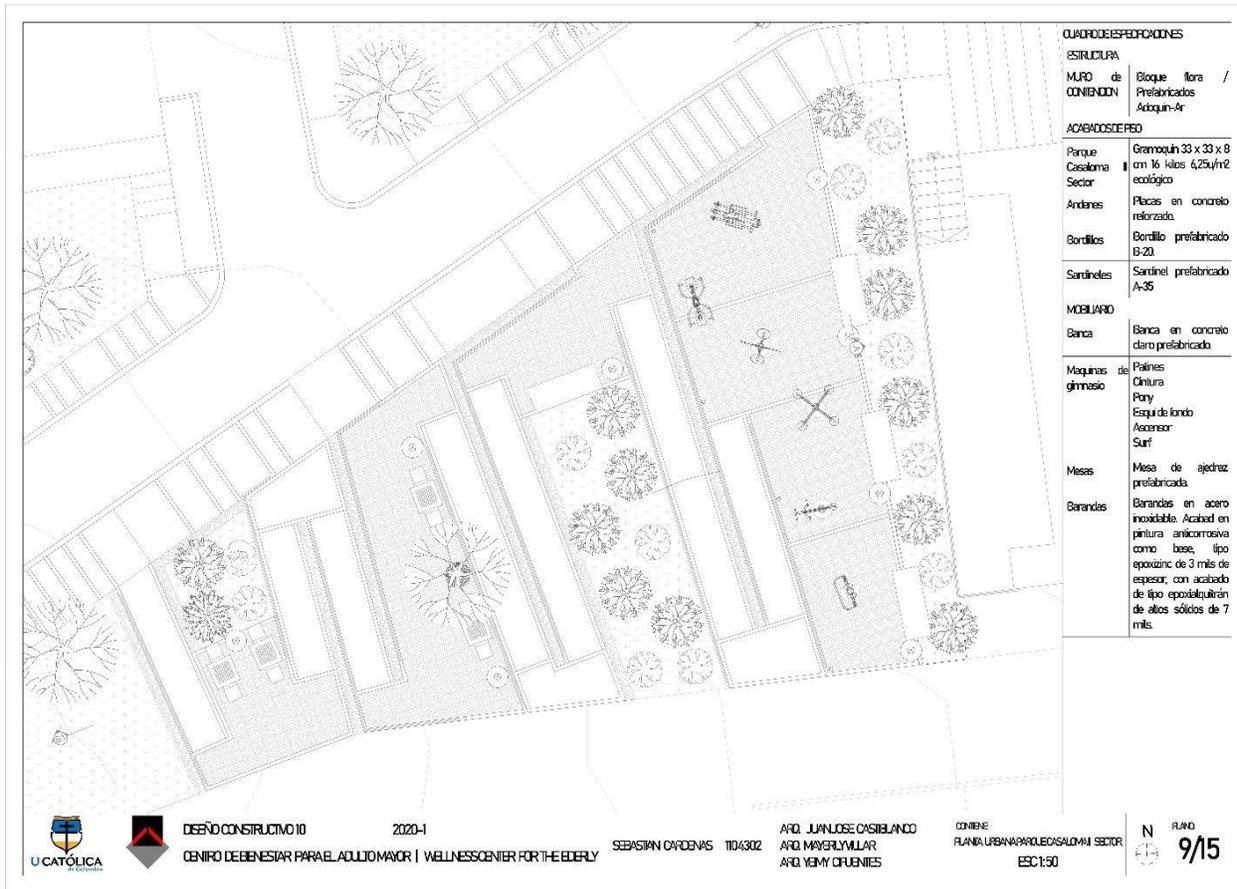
Planta intervención de espacio público Parque Casaloma II Sector.
